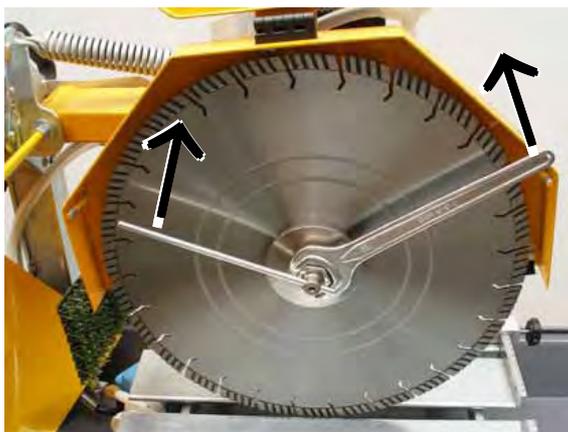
, Blattdruckflansch mit Schneidwellen-Mutter an Trennscheibe spannen
